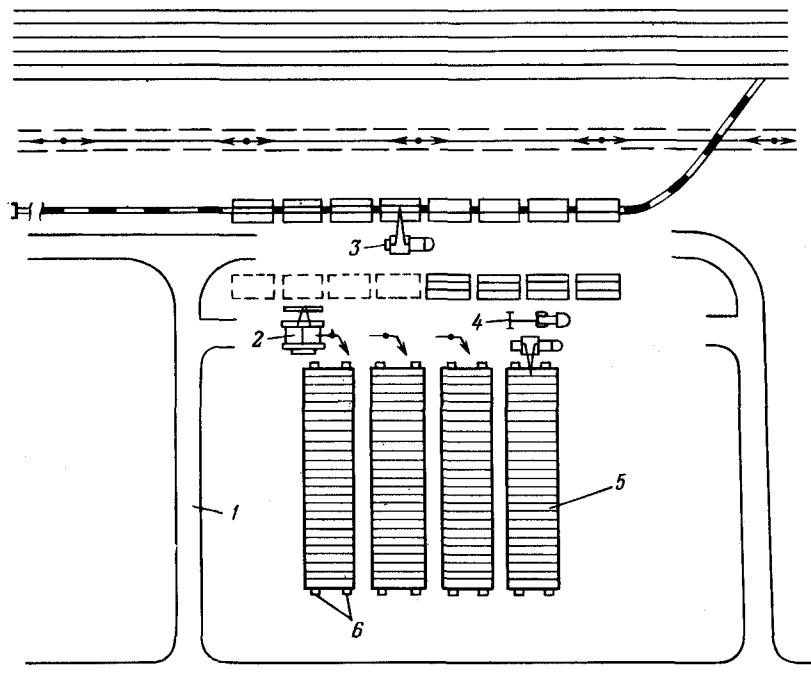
Примерный генплан труборазгрузочной площадки:
